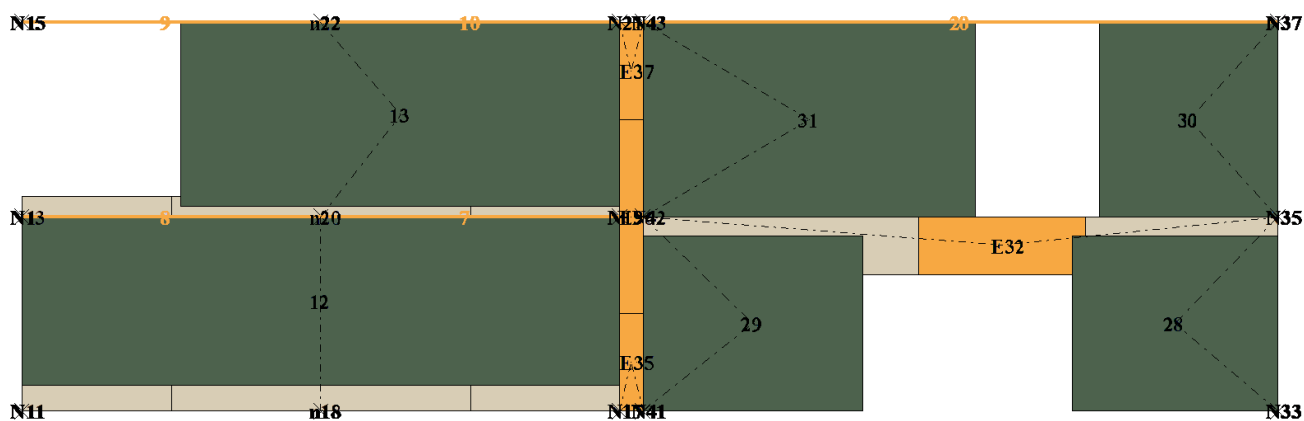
Prospetto Parete 3 - Modello Scollegato
